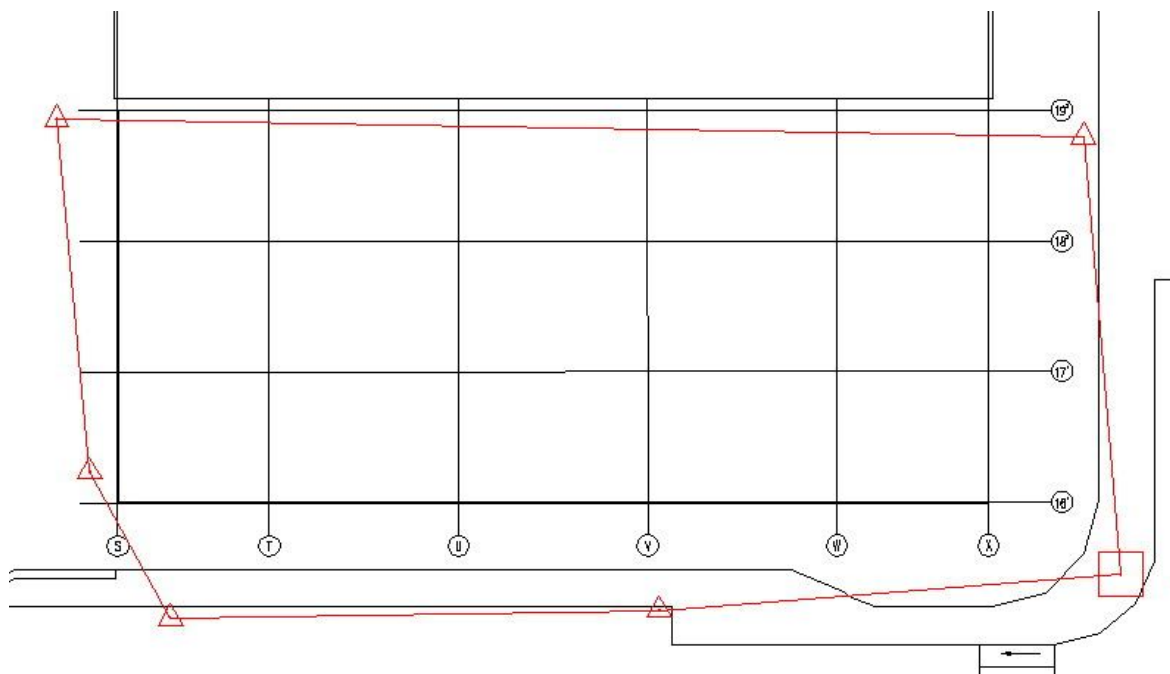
Схема разбивочной сети для корпуса №14.
